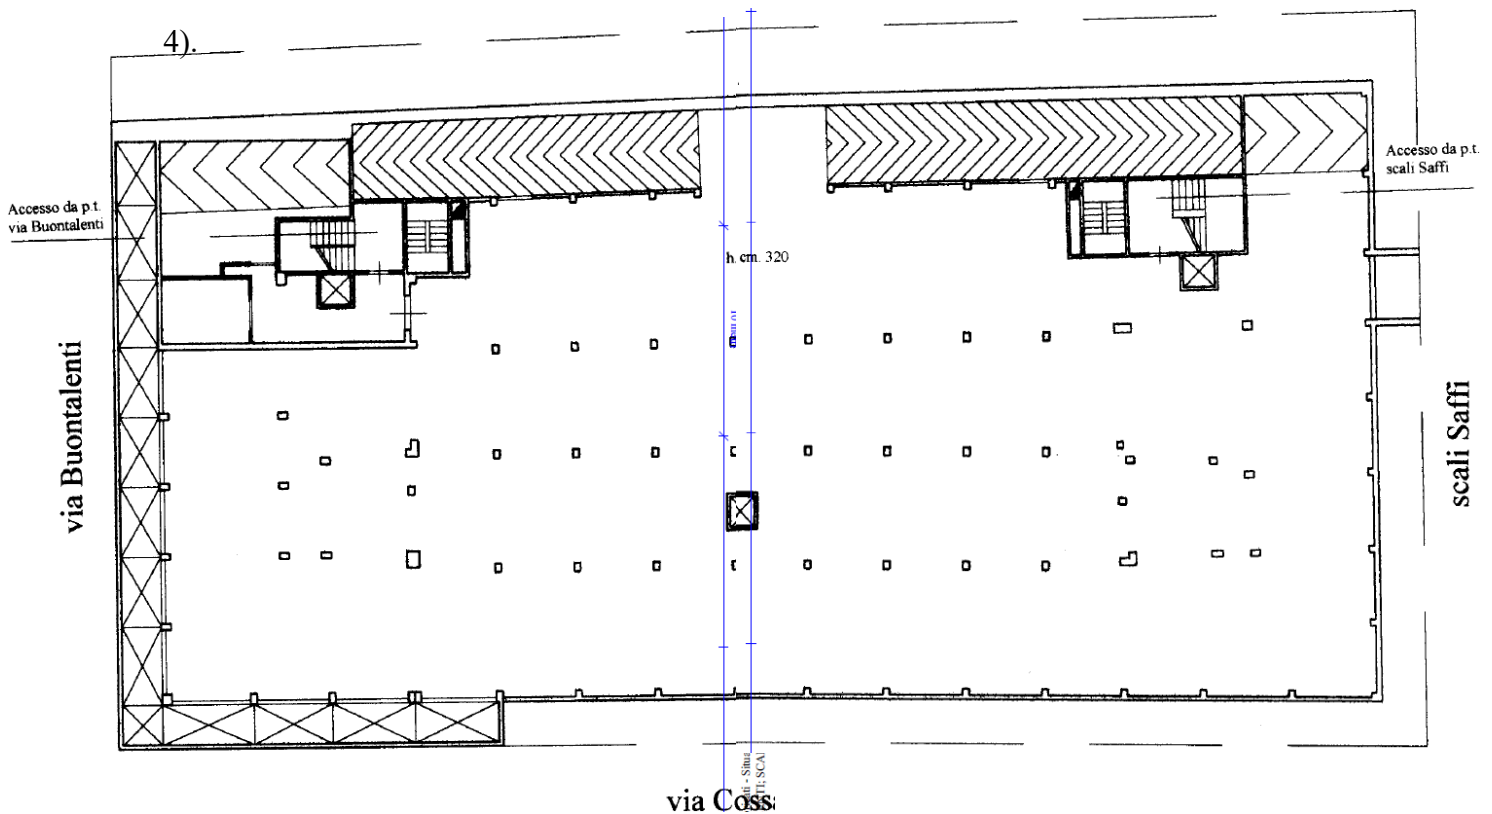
Estratto della planimetria catastale del magazzino posto al piano primo interrato S1
